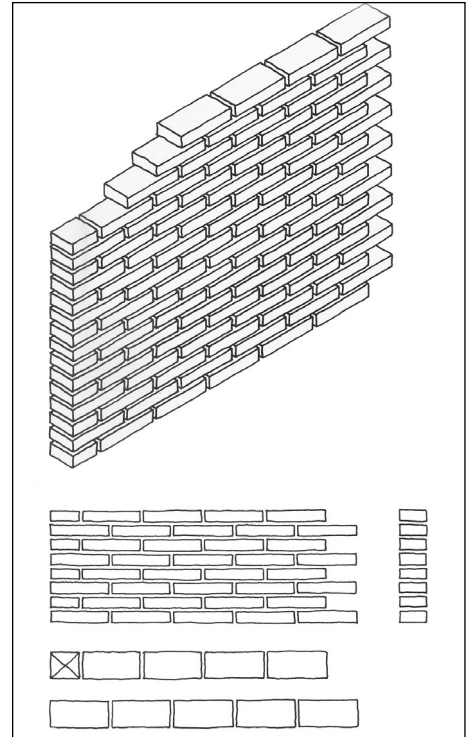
Muro ad una testa concatenato a cortina. Veduta assonometrica, prospetto, sezione e pianta dei corsi di mattoni (Immagine tratta da A. Acocella, *L'Architettura del Mattone faccia a vista*, Roma 1989.)
